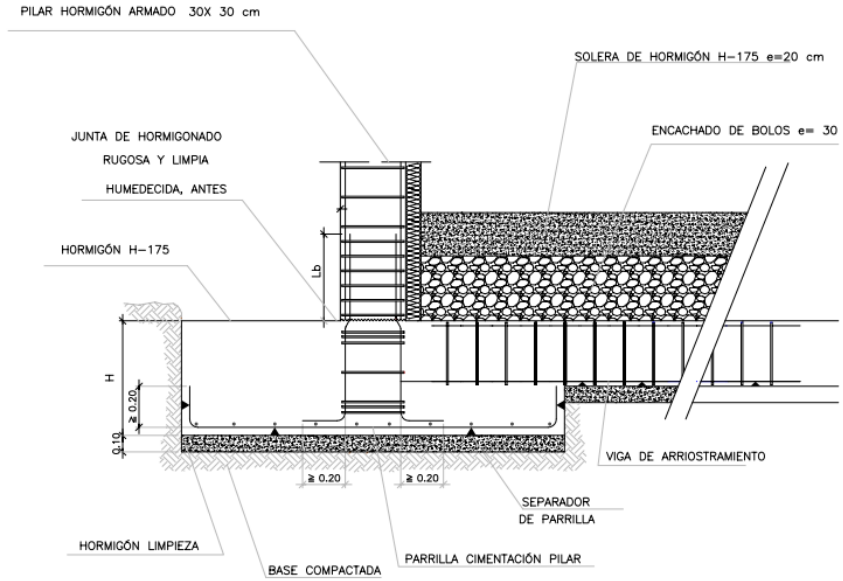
Detalle encuentro cimentación. Año 2015. Fuente propia.
